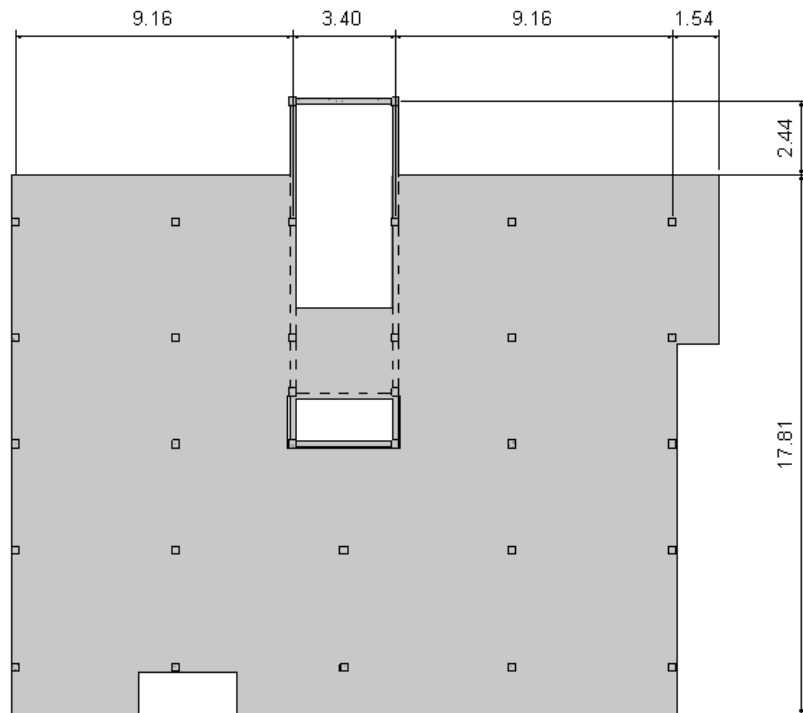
Planta estrutural do piso tipo da solução estrutural 1 (Revit).
